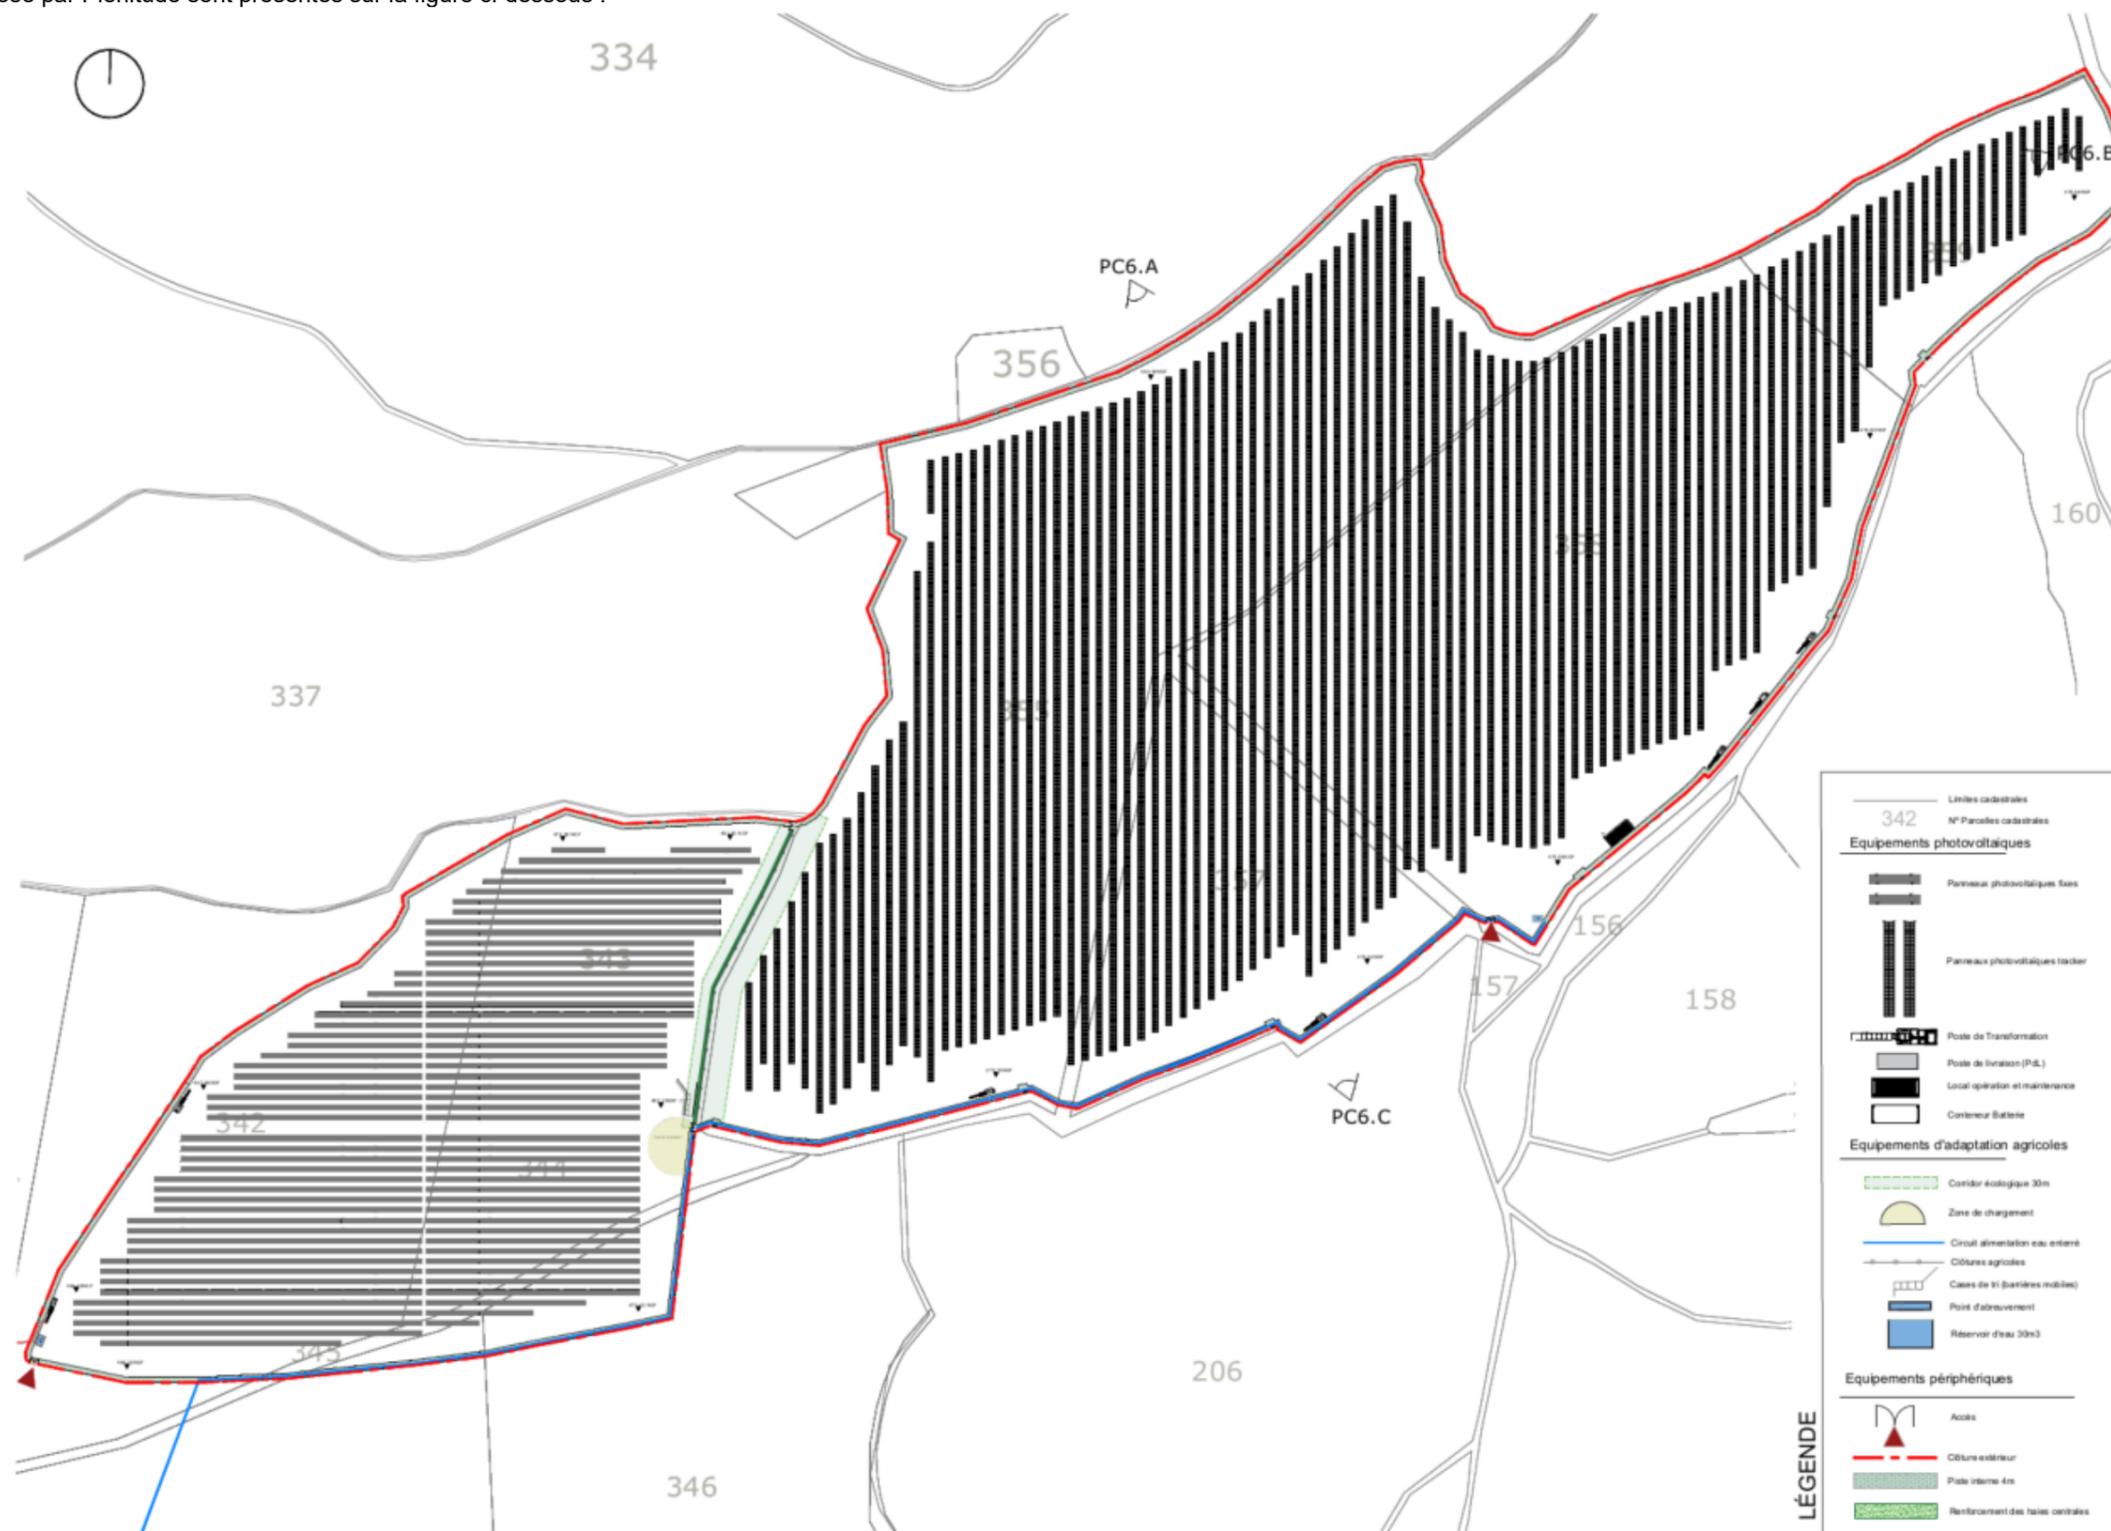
Schéma d'implantation du projet (source : Plenitude)
